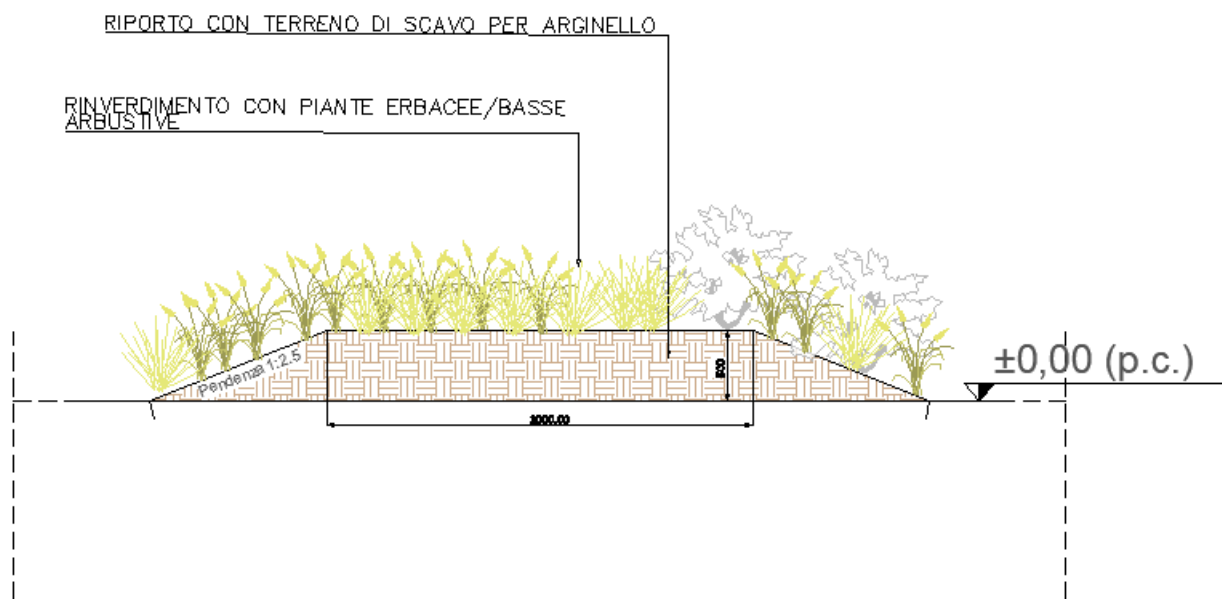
Tipologico argine perimetrale AP1, a protezione del lotto 1- sezioni A e B.
